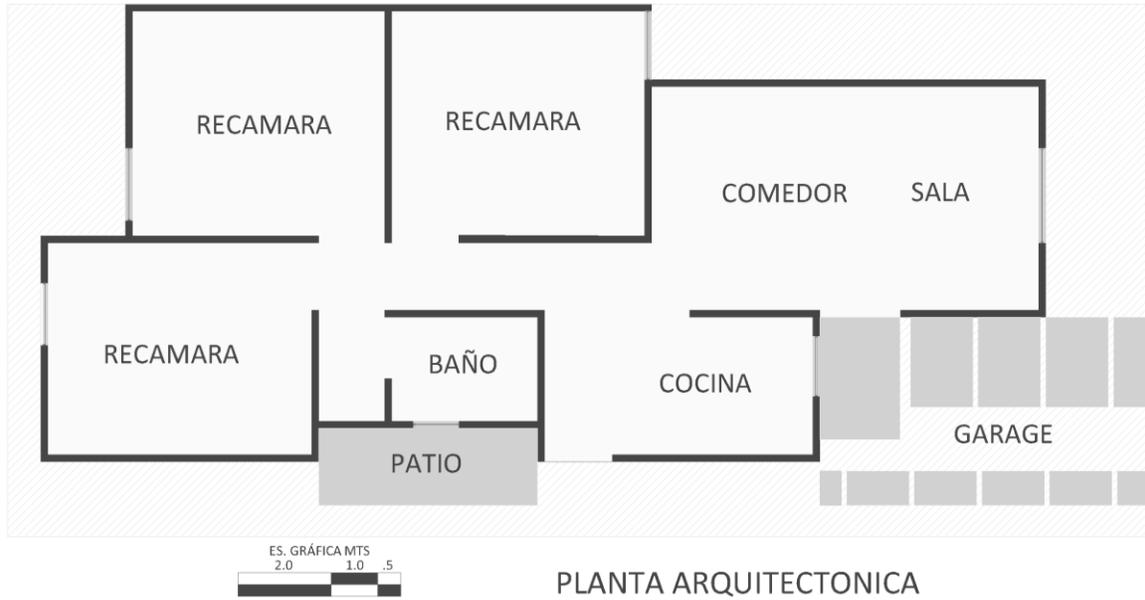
Planta Arquitectónica, sección los Cirios. Fuente: Dibujo propio en base al proyecto del Fraccionamiento.
